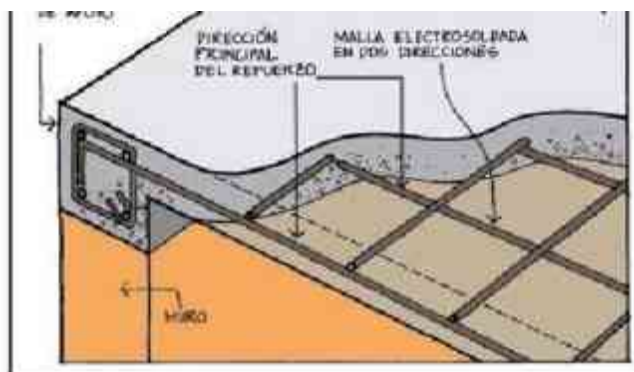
, Aplicación de sistema constructivo losa maciza. Fuente: Fotografía del autor.
